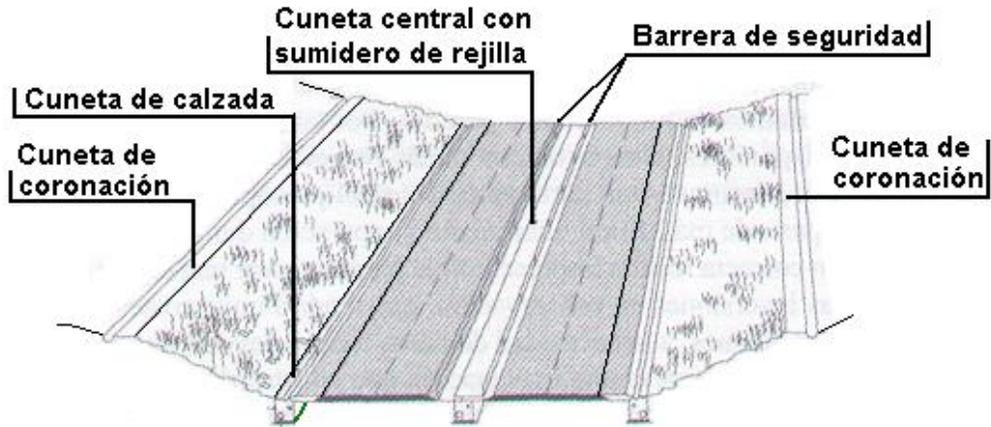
a: Sección Transversal en "Trinchera" en Vía de Calzada Dividida.
